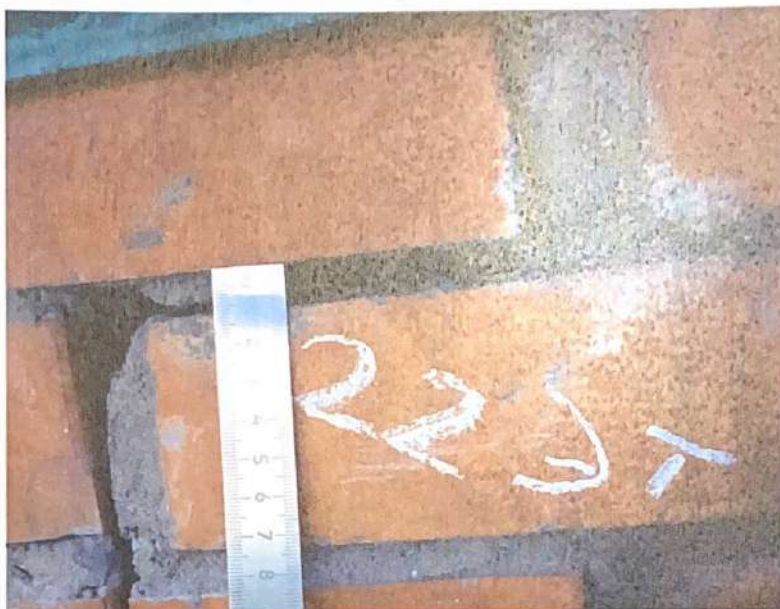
Секция 11. Фасад 2. Правый угол. Разрушение кладки в зоне примыкания металлоконструкций.
